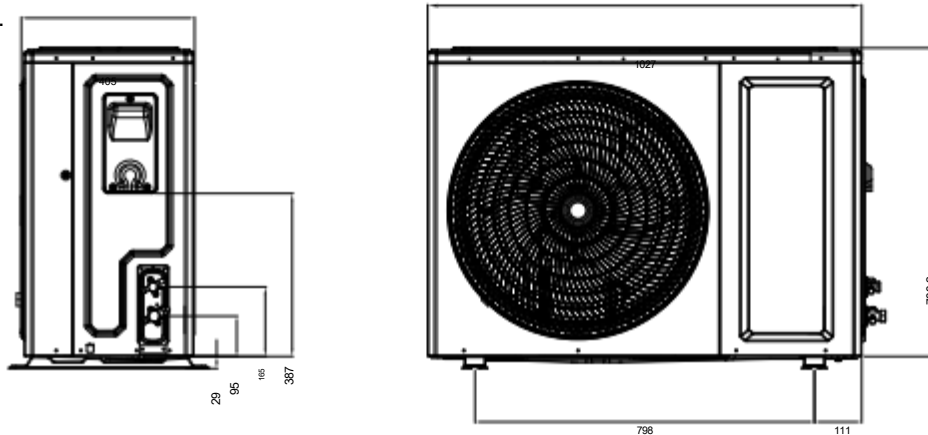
：7.5kw外机外观尺寸图 Fig. 2-6: Outline Dimensions of 7.5kW Outdoor Unit
